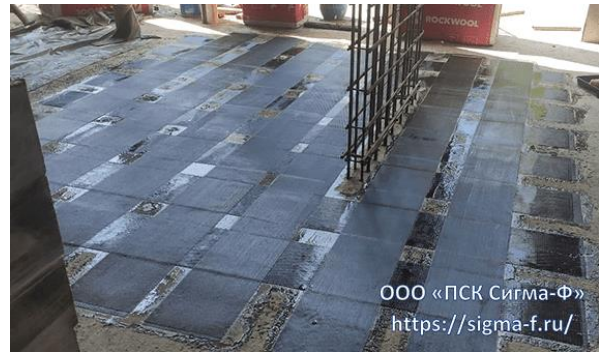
Усиление монолитного перекрытия многоэтажного здания, г. Москва, 2022 год
